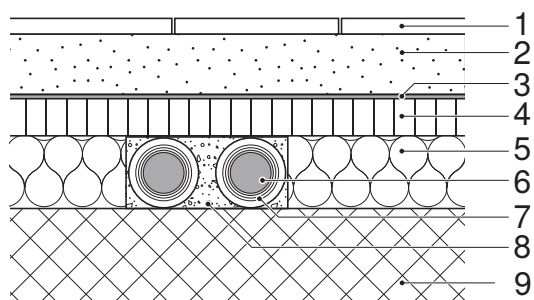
Colocación de tuberías sobre la losa de hormigón bruto
